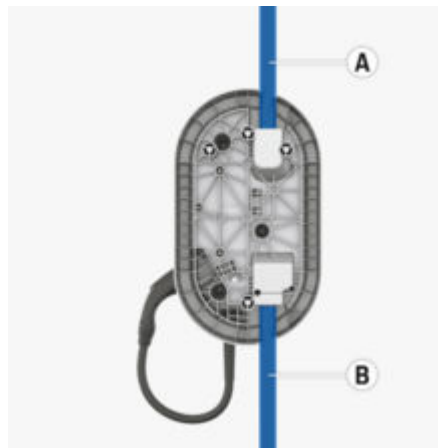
El acceso al cable superior e inferior (vista trasera del Wall Charger Connect, los conductos de los cables están marcados en azul)
